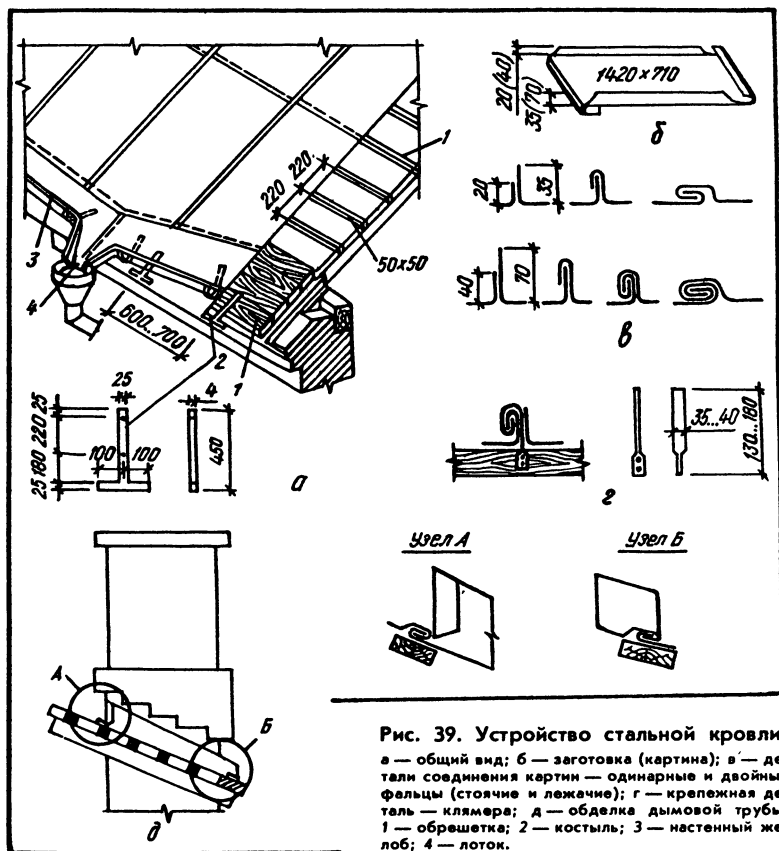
Устройство стальной кровли: а — общий вид; б — заготовка (картина); в — детали соединения картин — одинарные и двойные фальцы (стоячие и лежащие); г — крепежная деталь — клямера; д — обделка дымовой трубы; 1 — обрешетка; 2 — костыль; 3 — настенный желоб; 4 — лоток.
